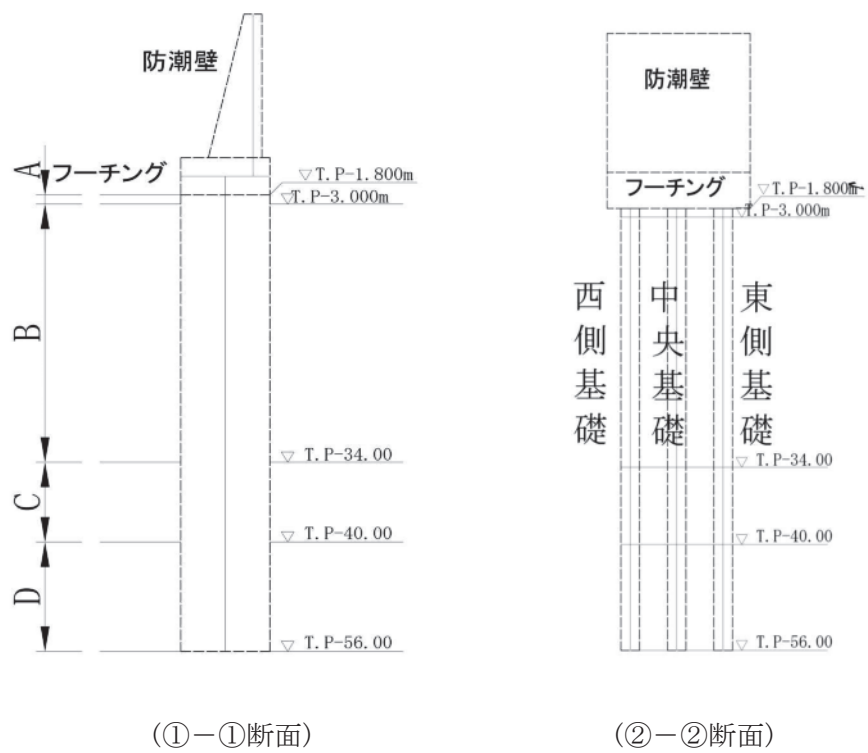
(2) 防潮堤（鉄筋コンクリート防潮壁）の照査位置図
